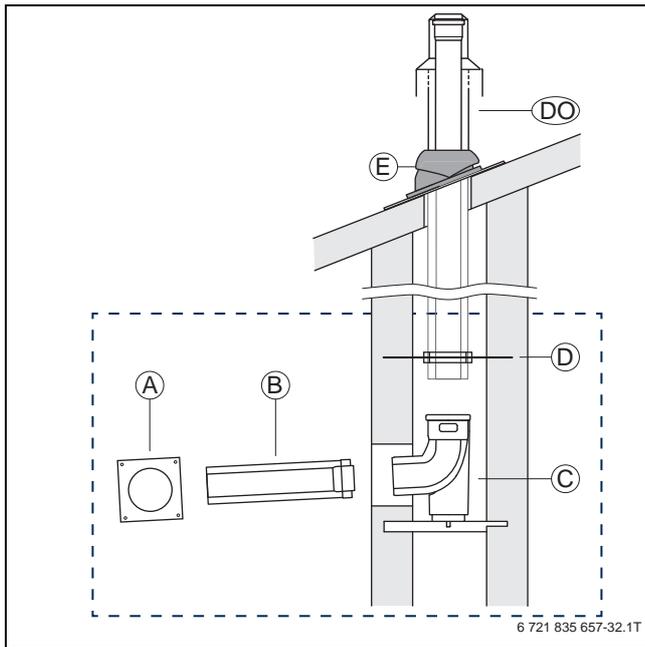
Bauteile Grundbausatz DO-S in DN 110/160
